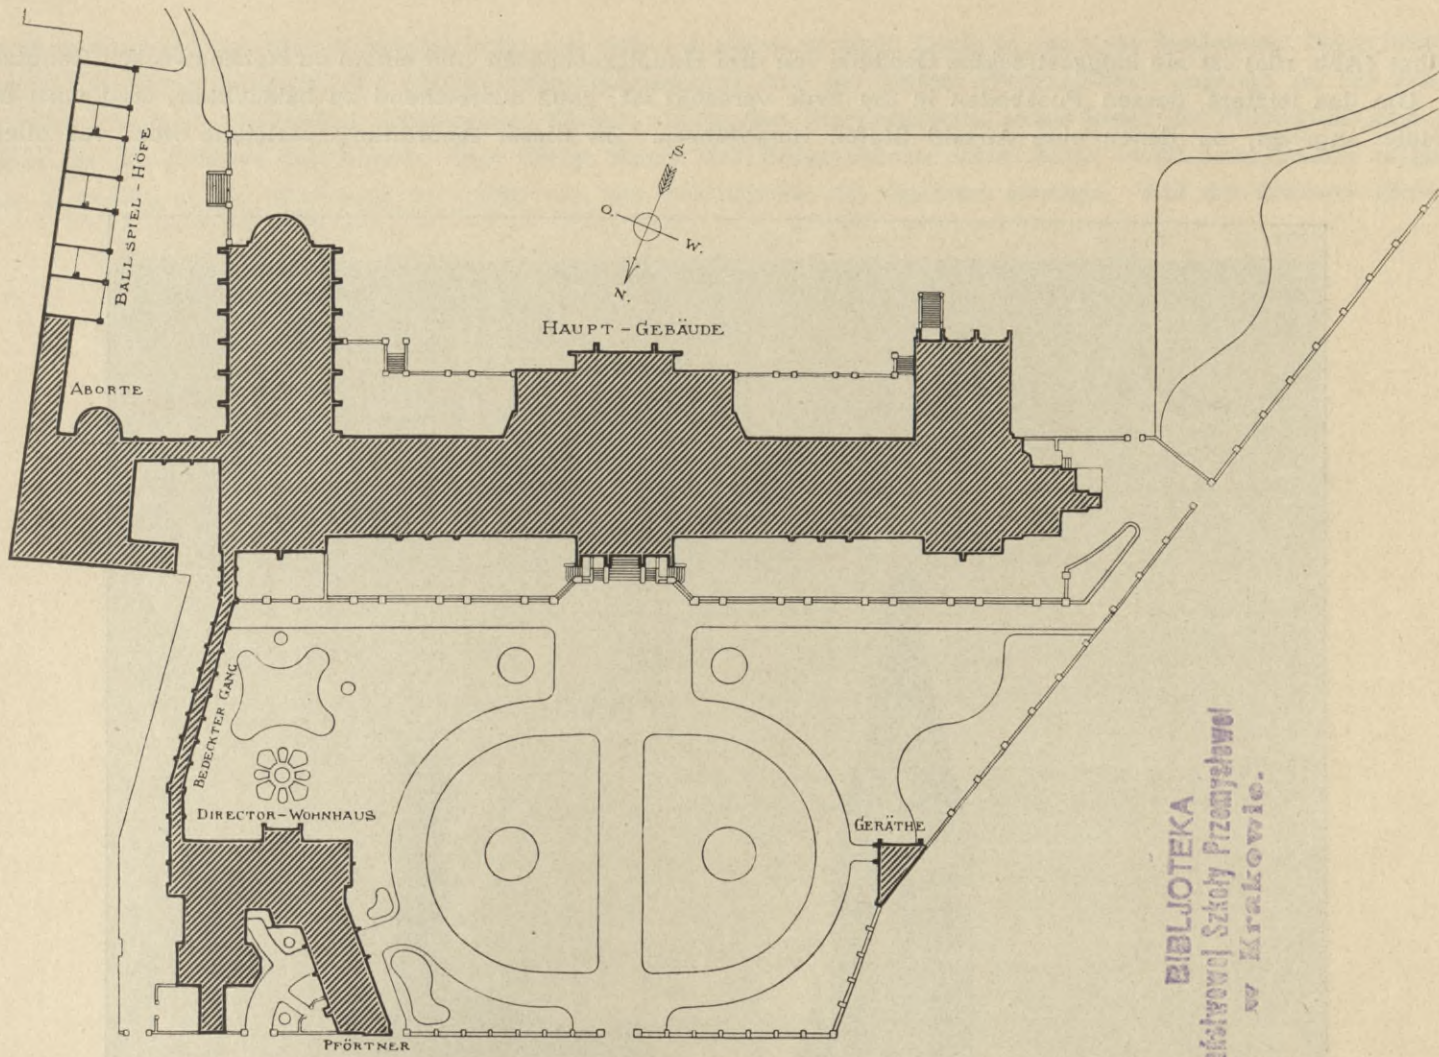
Paulschule in Hammersmith, London, Lageplan.
